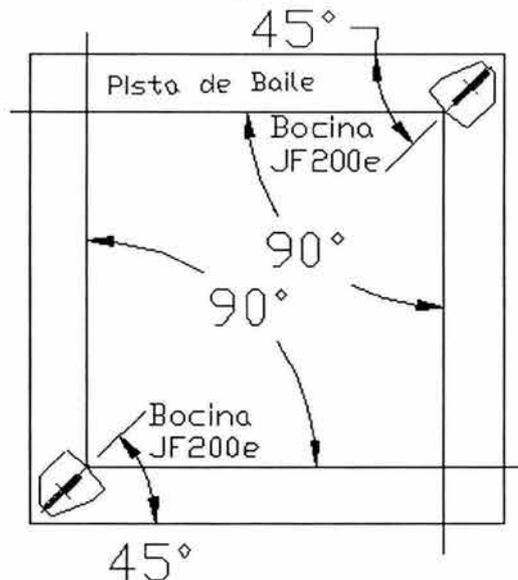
Arreglo de bocinas horizontal para la pista de baile
